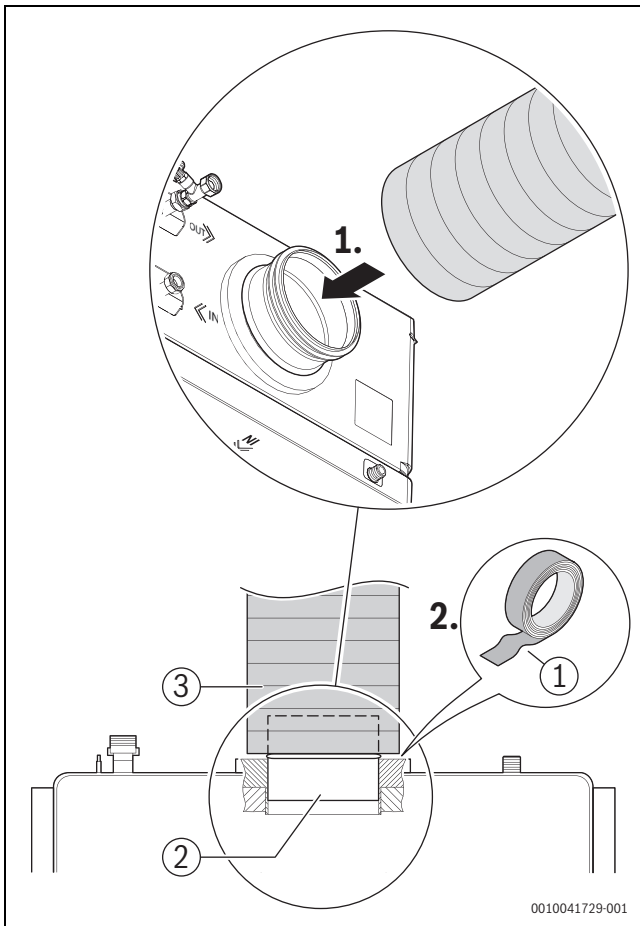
Aufbau Luftrohranschluss mit isoliertem Rohr
